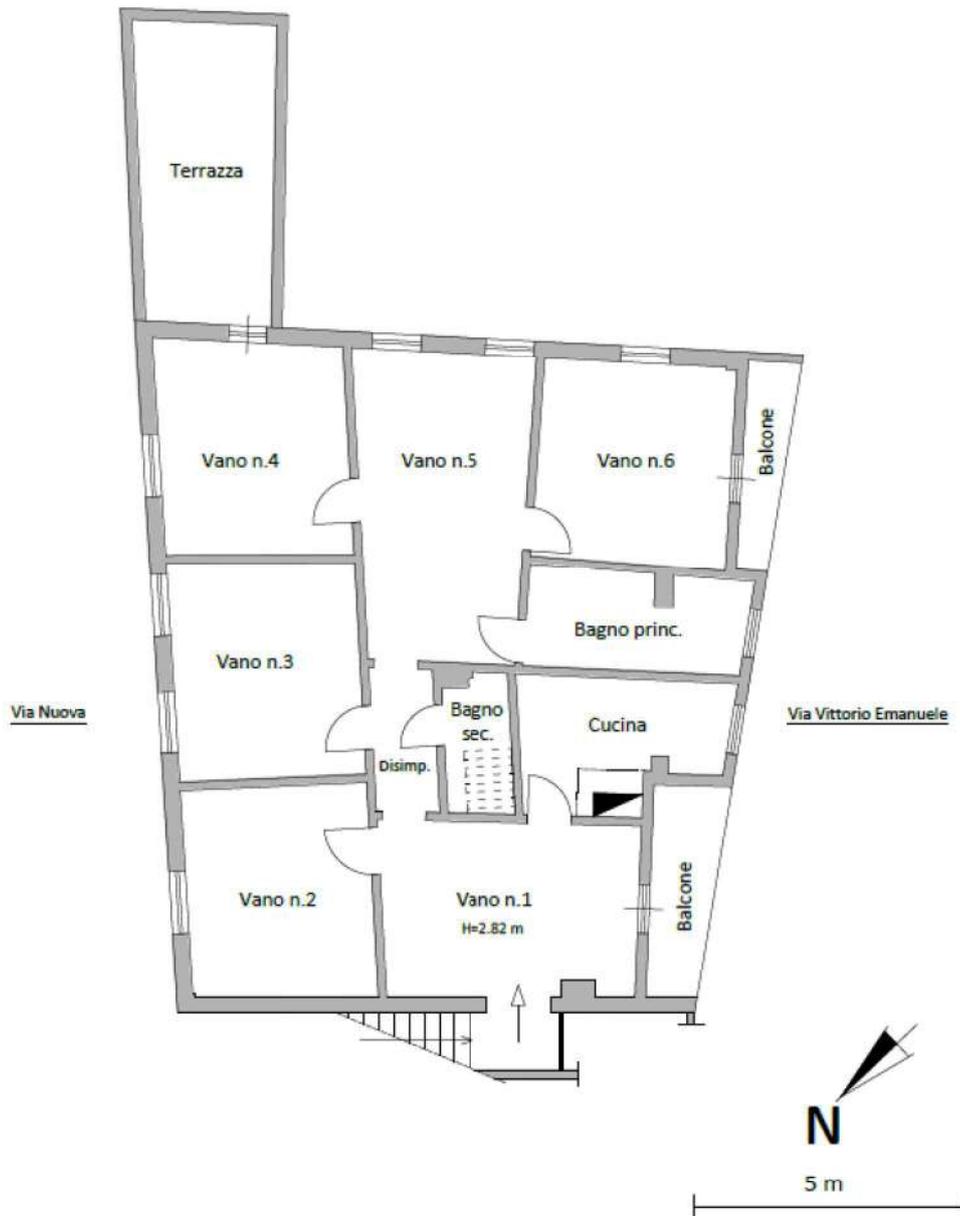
Planimetria dello stato reale dei luoghi - Appartamento al Piano 2°
